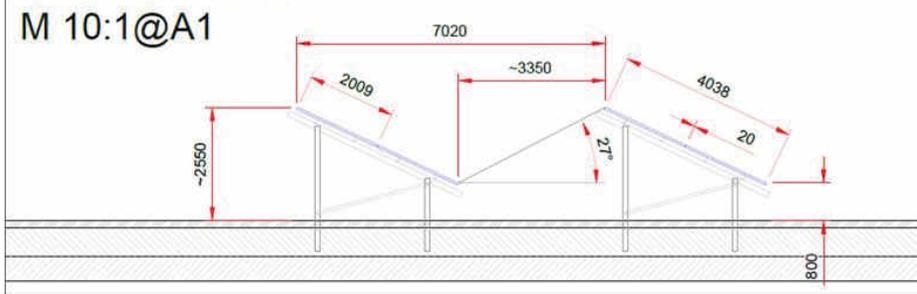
Coupes schématiques des tables d'assemblage sur les pistes bétonnées
